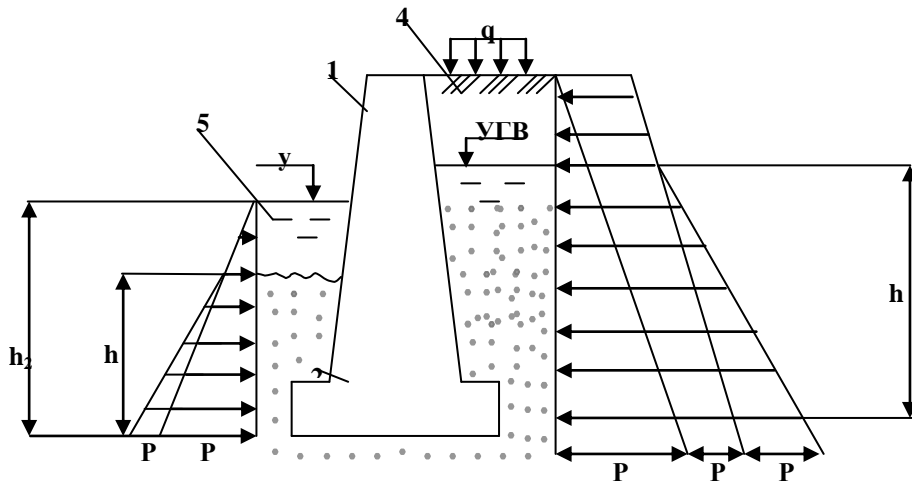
Тиск на підпірну стінку: 1 – підпірна стінка; 2 – обріз фундаменту стінки; 3 – підшошва фундаменту стінки; 4 – ґрунт засипки; 5 – річка
